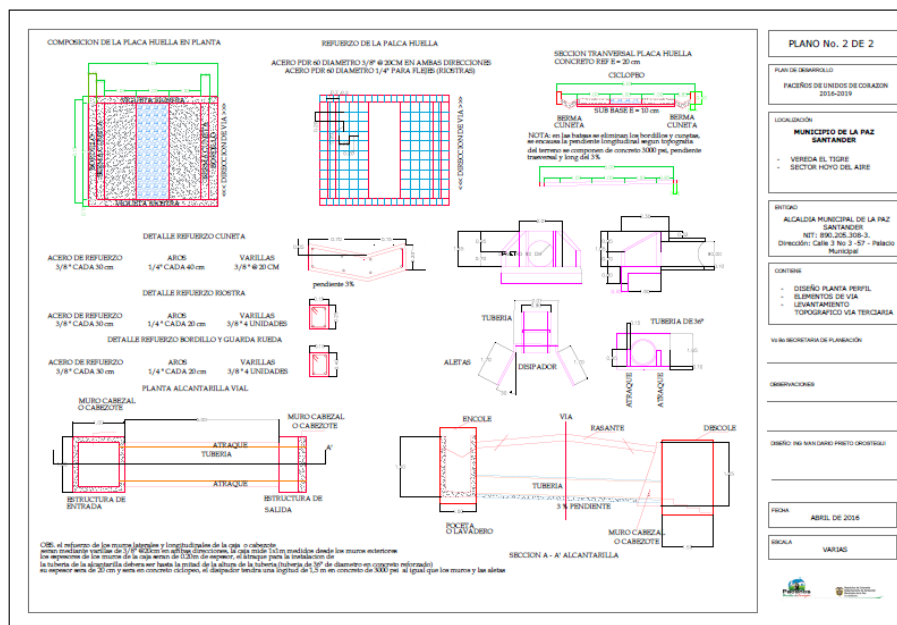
Planos estructurales de placa huellas y alcantarillas.
